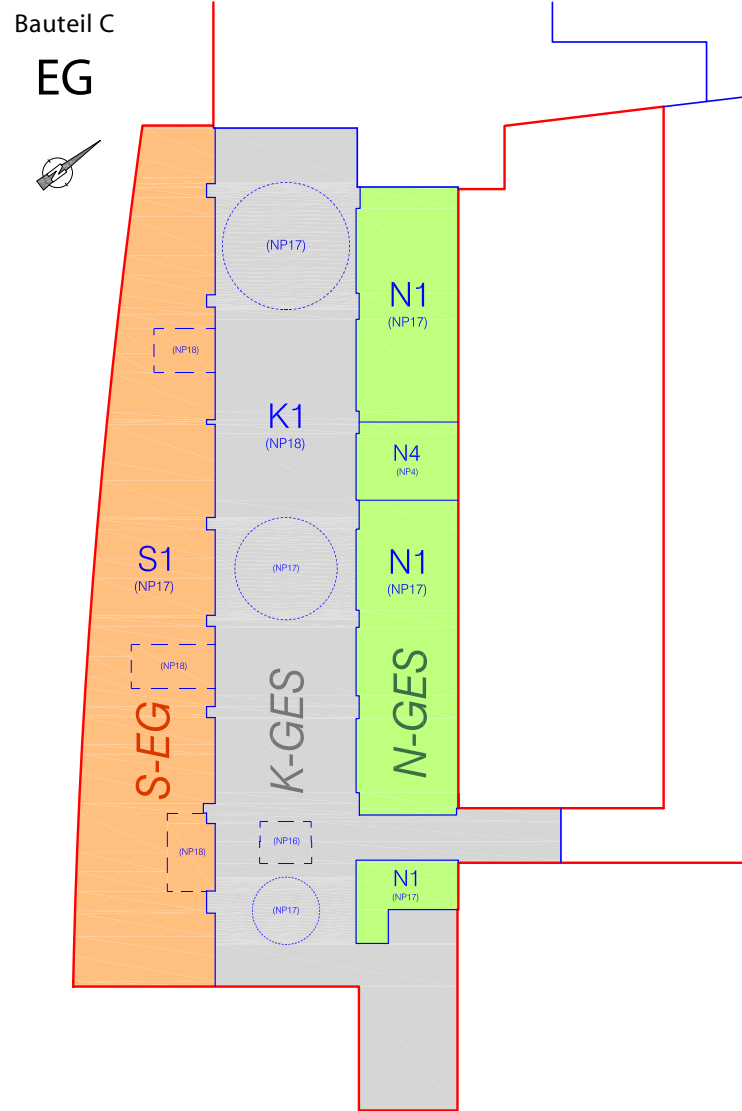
Zonierung Bauteil C – Teil 1 (Erdgeschoß - 1. Obergeschoß)
